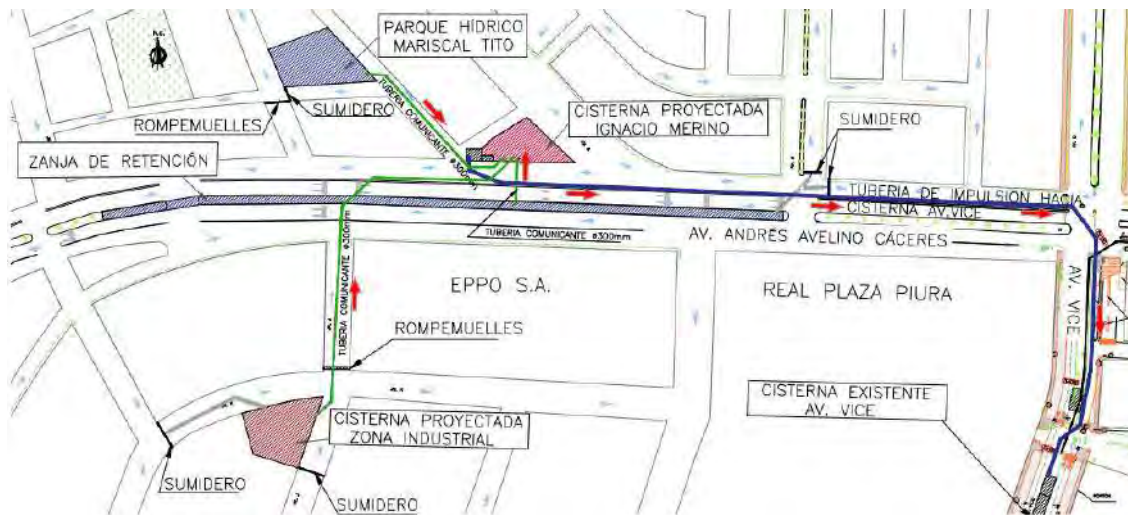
Vista en planta de las estructuras hidráulicas del sistema 1
